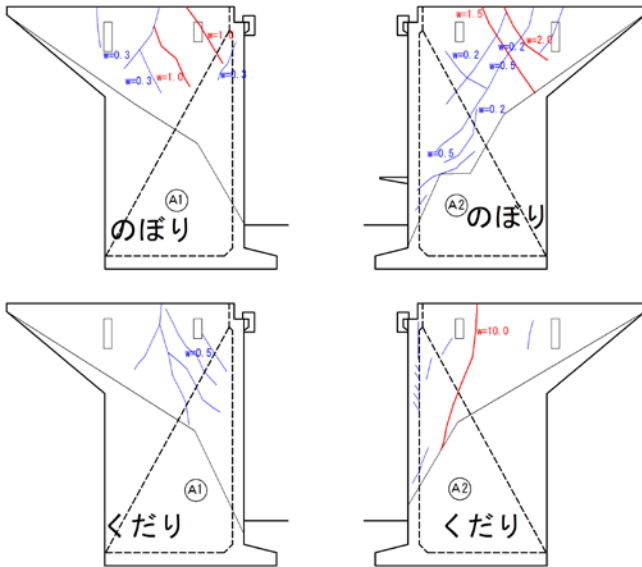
既設ウイングひび割れ概要図(赤:1mm以上)
